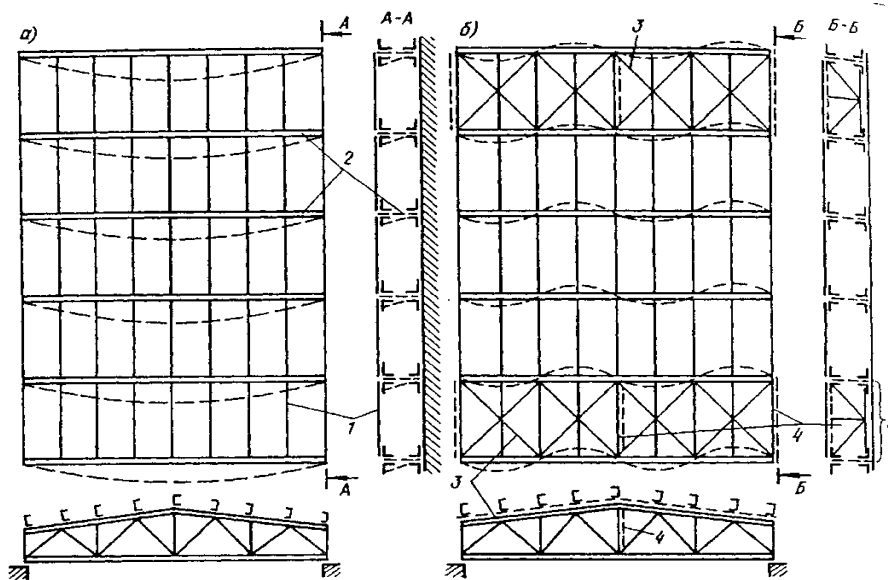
Зв'язки, що забезпечують стійкість кроквяних ферм
